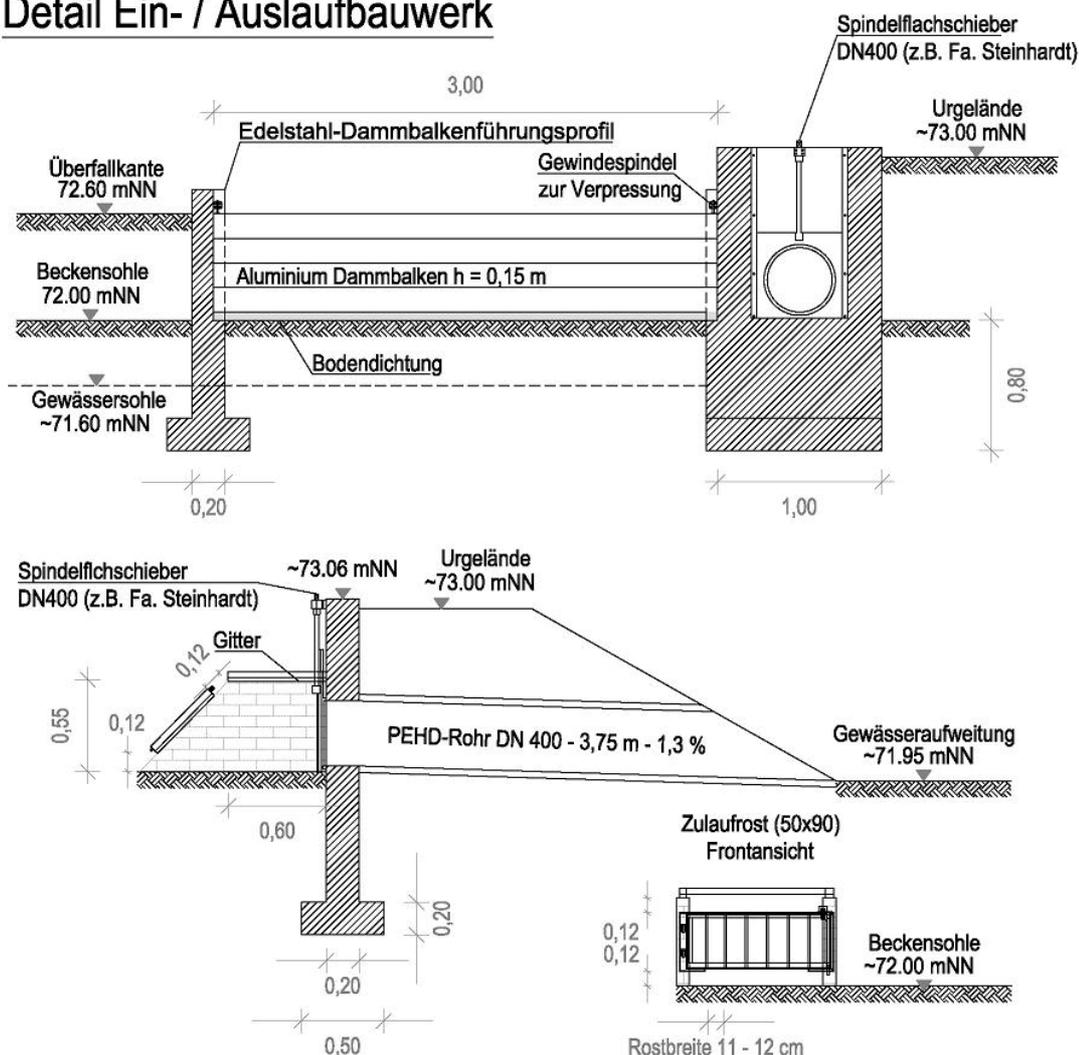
Prinzipskizze der geplanten Dammbalkensperre mit Auslaufbauwerk
